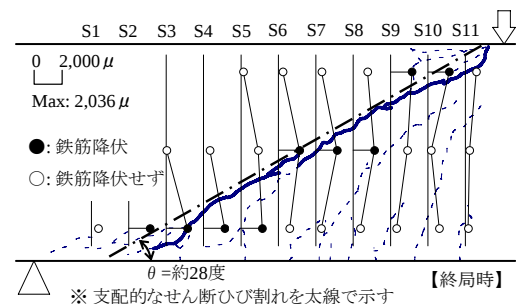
ひび割れとせん断補強鉄筋ひずみ(A 供試体)
